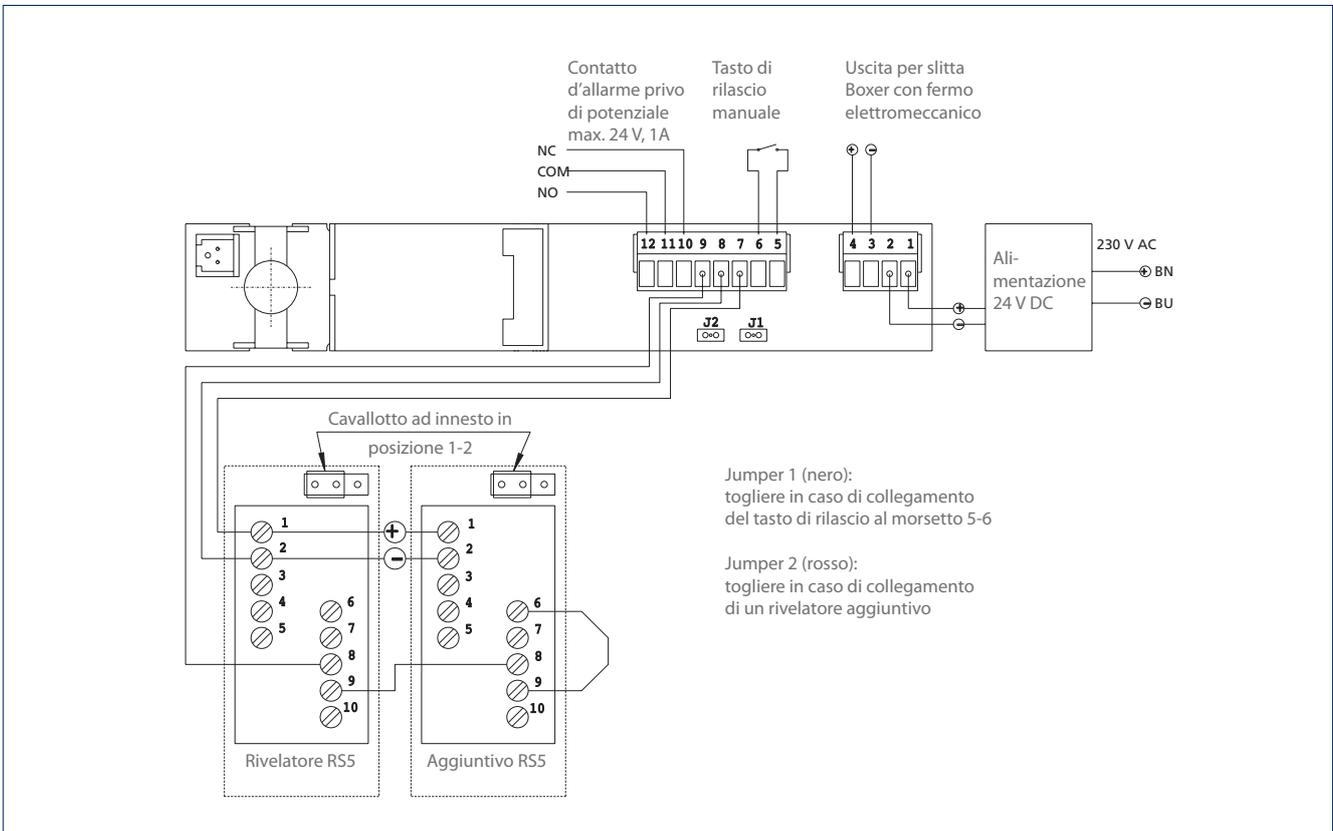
Schema di collegamento Boxer con braccio a slitta con fermo elettromeccanico e centralina rilevazione fumo RSZ 6
